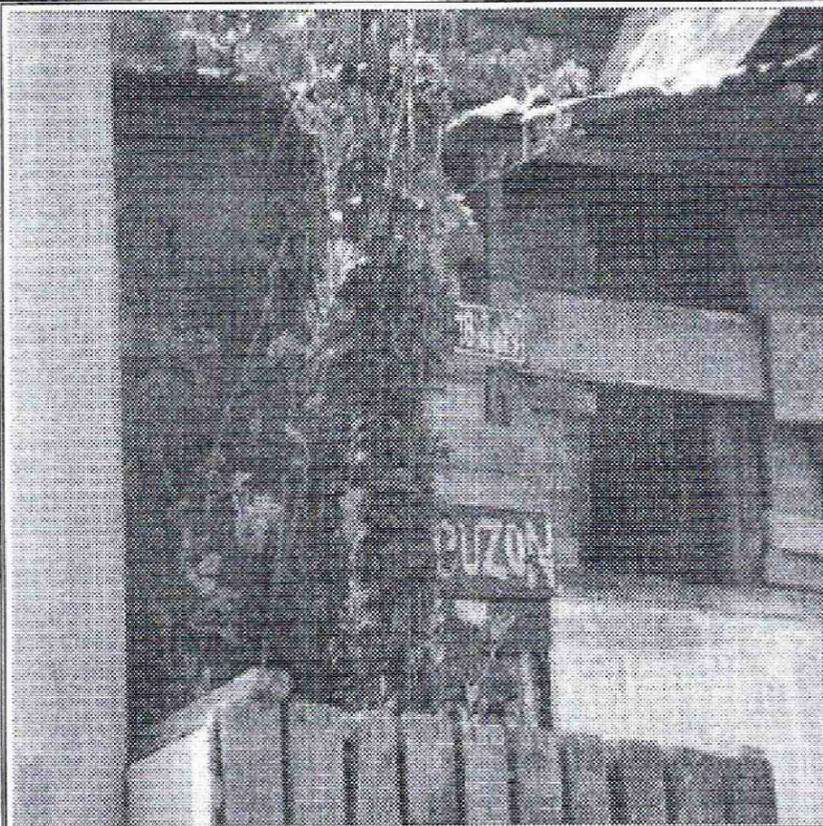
Vista frontal del predio de la Calle 81D Sur No. 18C-18 Barrio San Rafael Sur Localidad de Ciudad Bolívar
